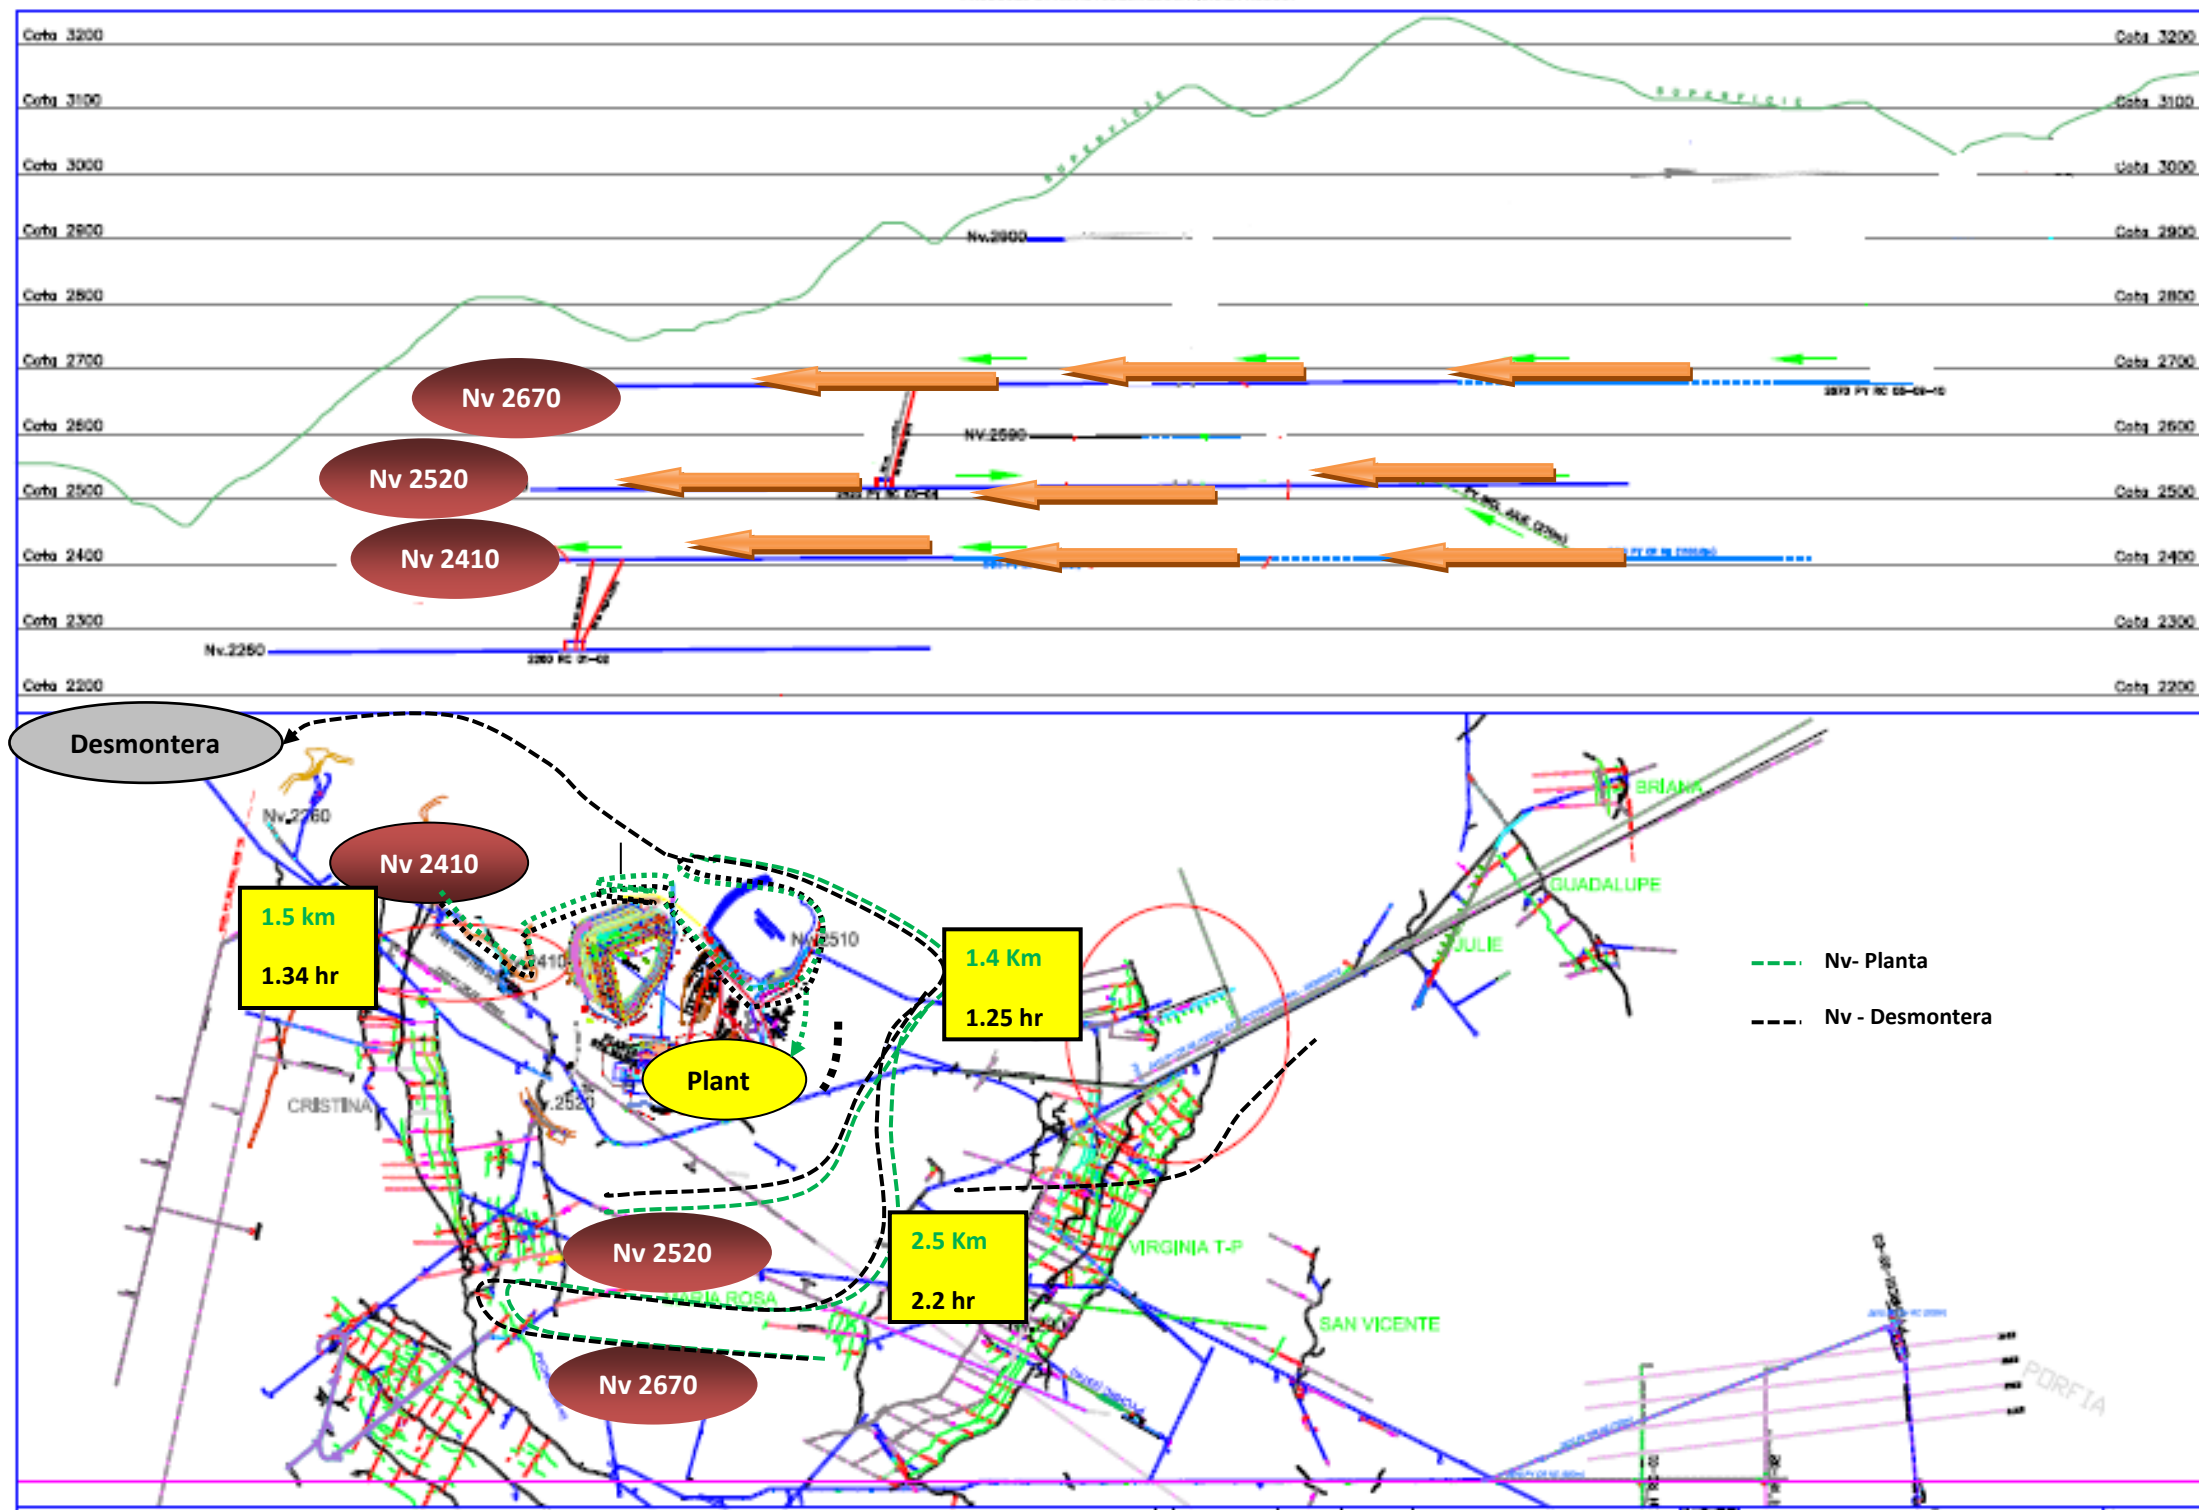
Vista de Perfil y Planta Antes del Proyecto
